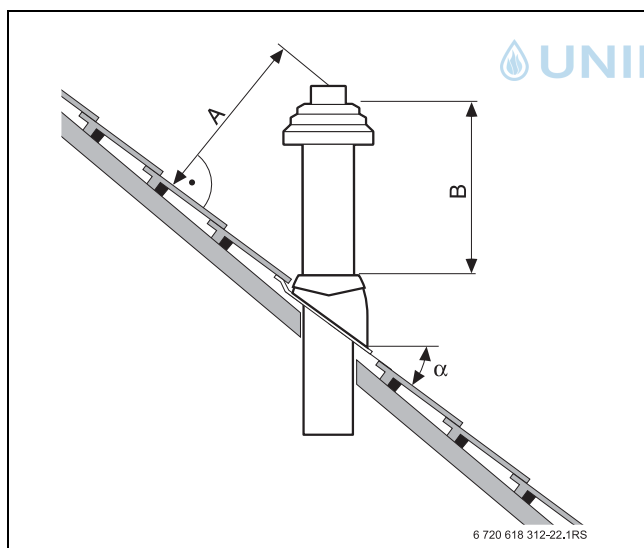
Abstandsmaße und Dachneigungen bei Schrägdach
